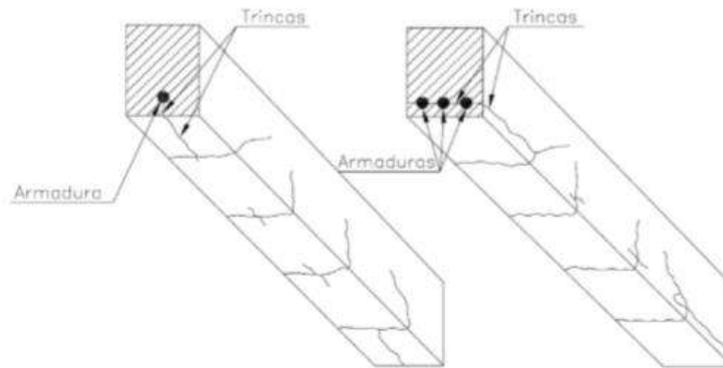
Fissuras e trincas de retração e/ou intempéries localizadas na alma
